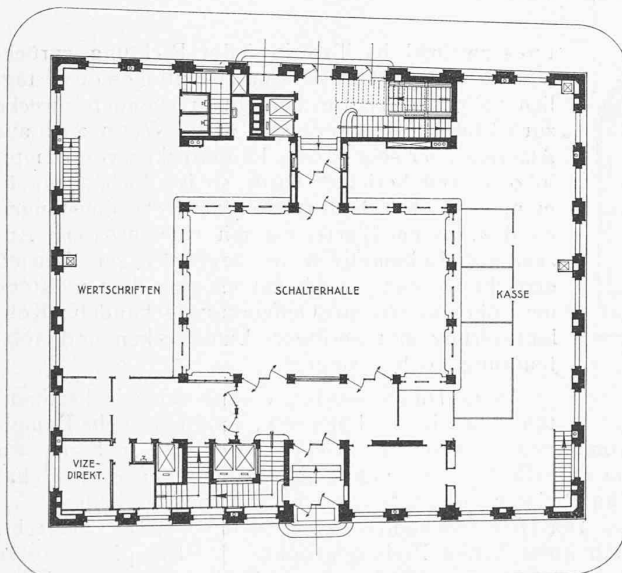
und 6. Grundrisse vom Erdgeschoss und 1. Stock 1 : 400 der Genfer Filiale der Schweizerischen Kreditanstalt. — Arch. Maurice Turrettini (†), Genf.
